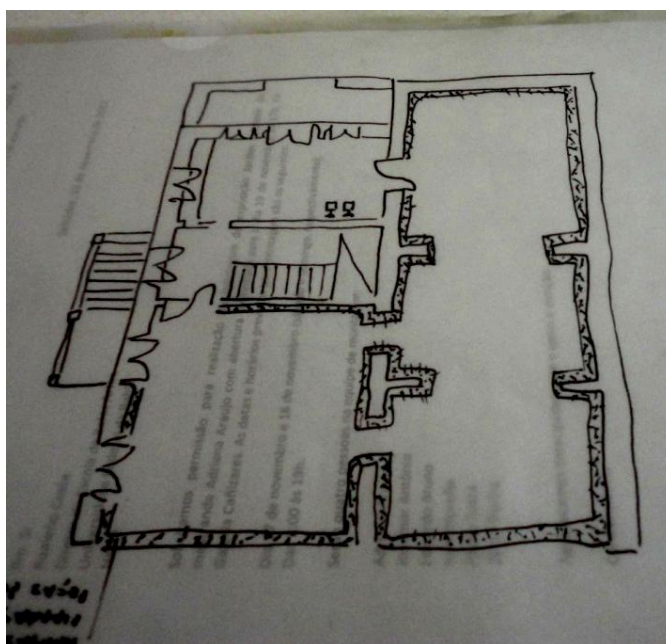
Primeiro esboço da instalação, planta baixa da Galeria Cañizares
